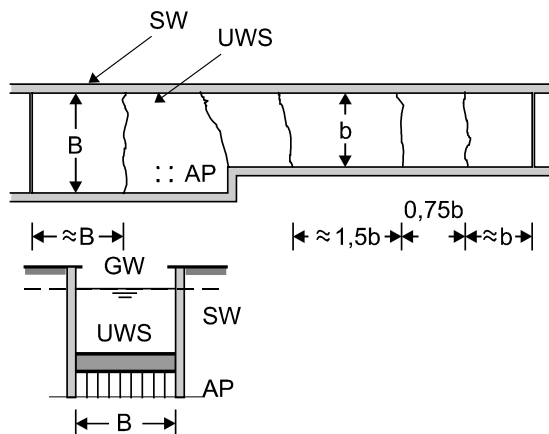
Risse in UW-Betonsohle zwischen Schlitzwänden SW und mit rückverankernden Pfählen AP
